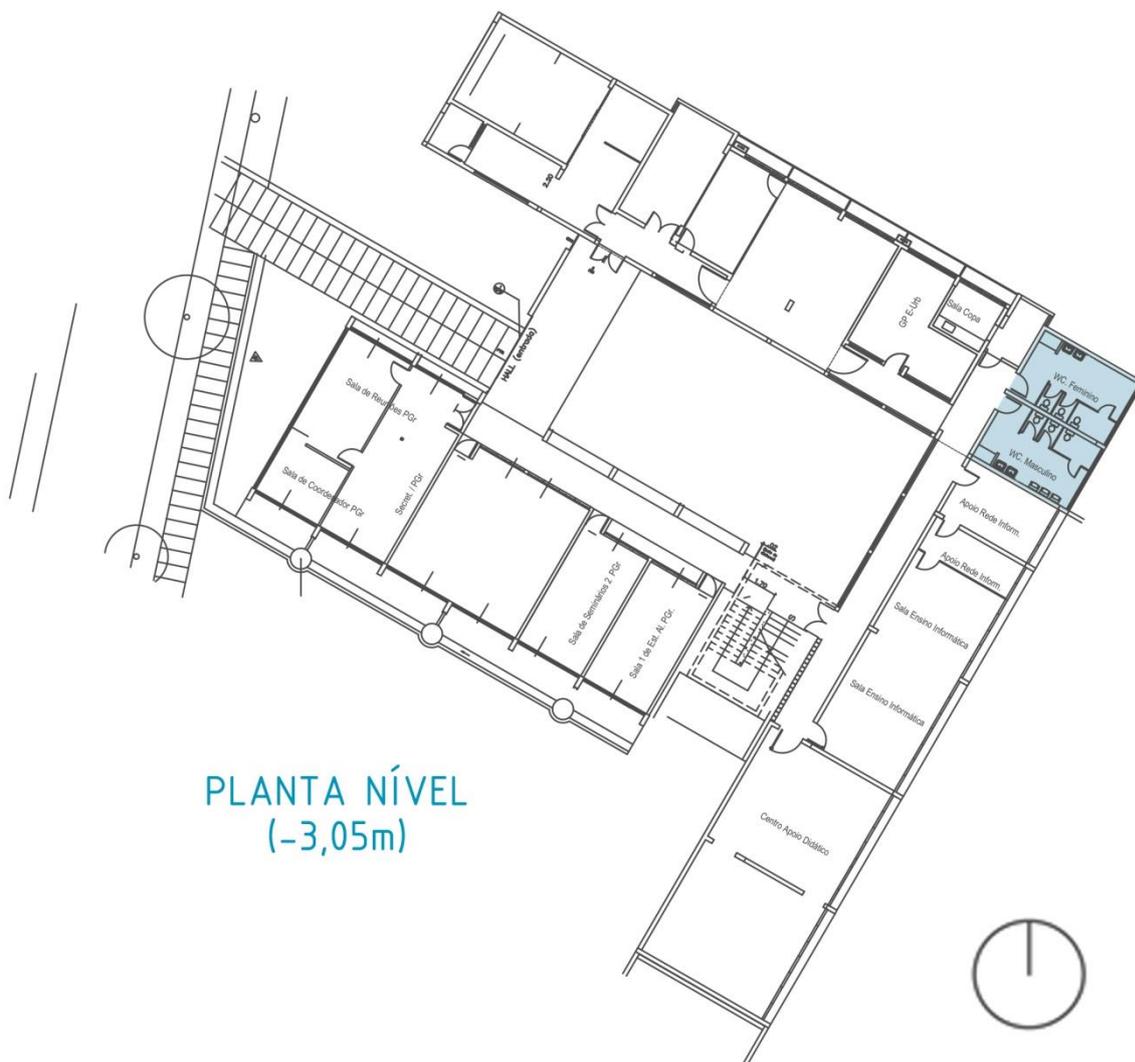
Planta do nível térreo do edifício, com detalhe da planta dos banheiros.
